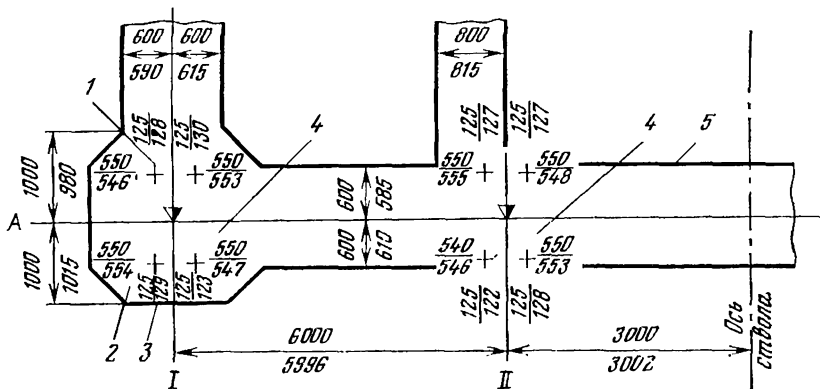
Исполнительная схема части фундамента под металлический башенный копер:
